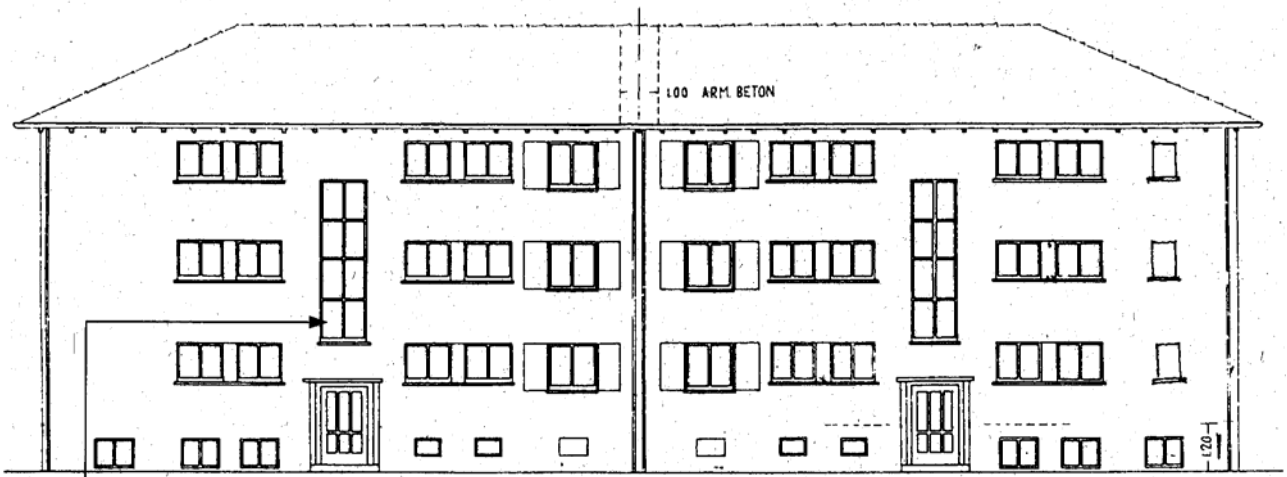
Immeuble Friestrasse 28/30 - Façade Est
